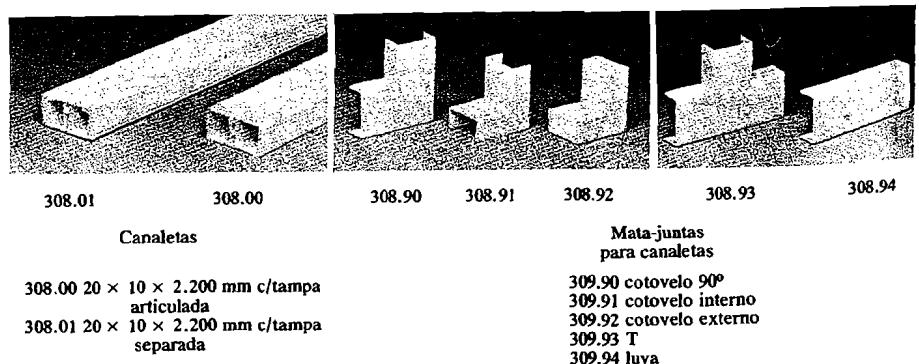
Sistema X Pial Legrand de canaletas de sobrepor, em PVC
